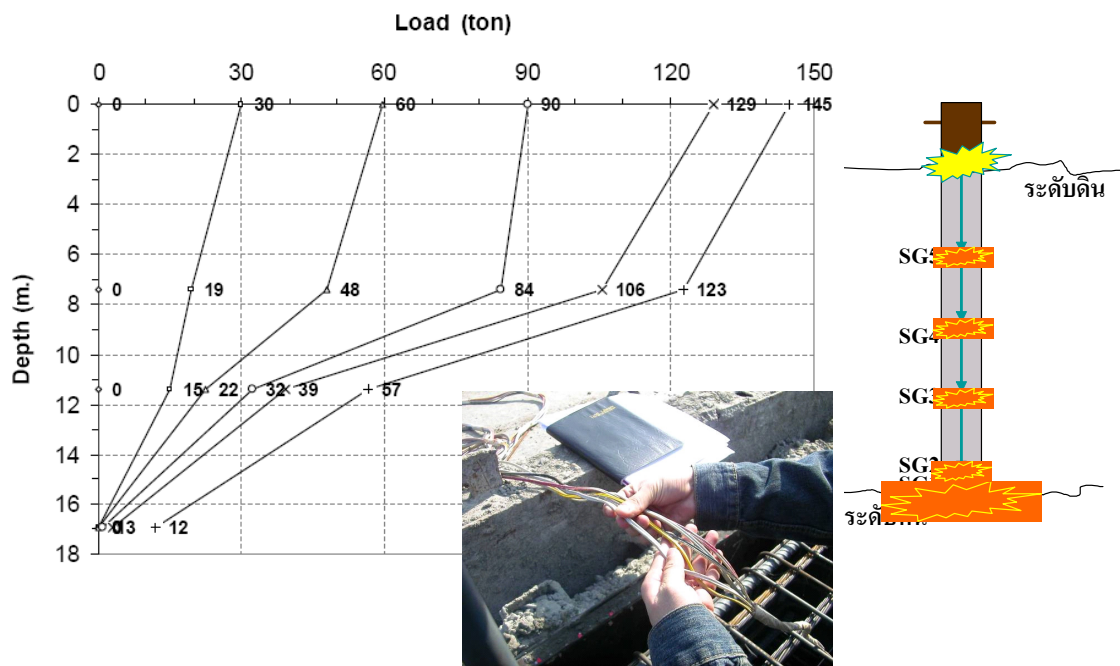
ผลการทดสอบ Static Pile Load Test เสาเข็มยาว 11 เมตร
